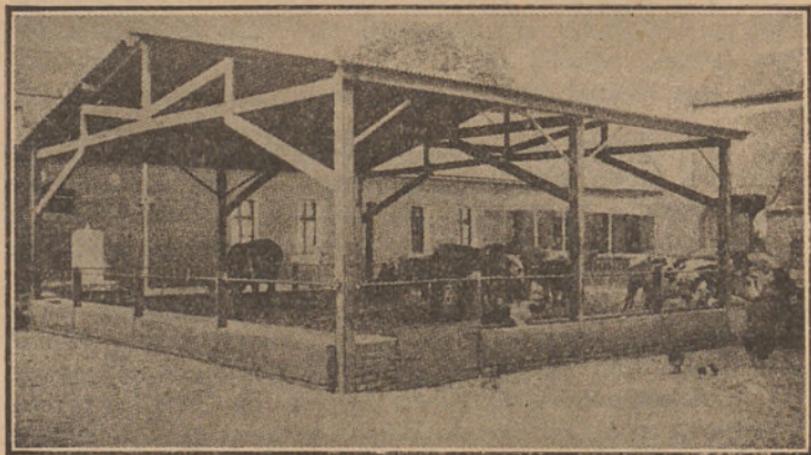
Estrumeira funda, coberta — de fibrocimento ou semelhante; colunas de madeira; paredes de resguardo, de tijolo rebocado, transformadas em manjedoura; quatro portas de serviço, de ferro ou de madeira, para entrada de animais, pessoal e carros de mão. O gado calca o estrume enquanto areja.
